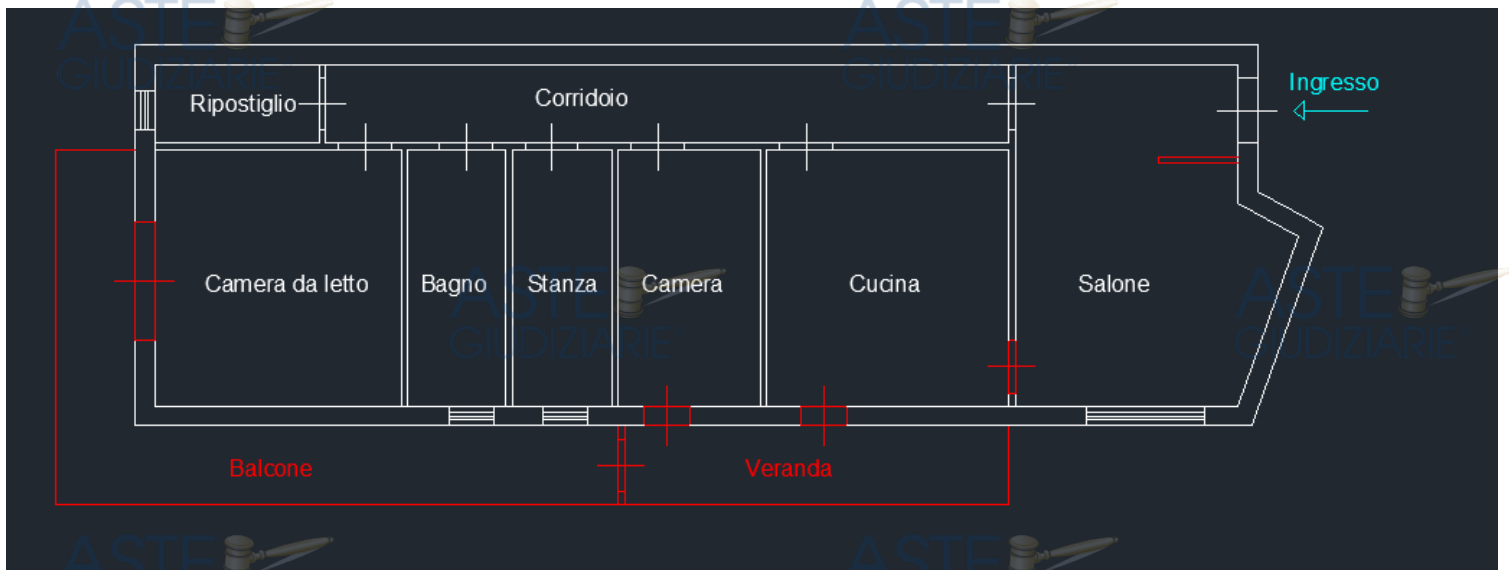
Planimetria allo stato di fatto (a seguito di sopralluogo)
